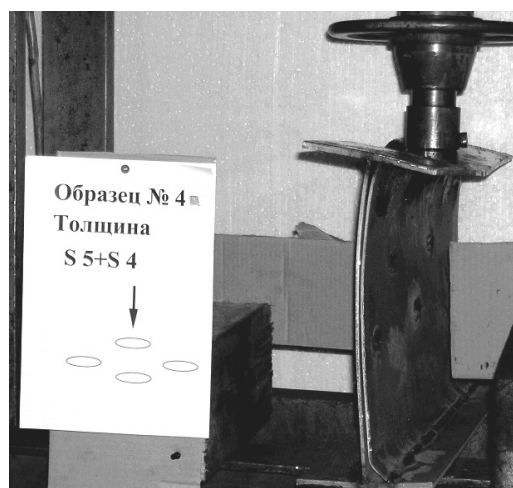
Испытание образца с дублированной стенкой (базовая стенка толщиной 5 мм; дублирующая 4 мм; вариант с нижним отогнутым под 45°, а сверху обжатым по сварному шву краем у листового накладного элемента в месте крепления к поясам балки; усилие прикладывается в месте расположения двух электрозаклепок)
